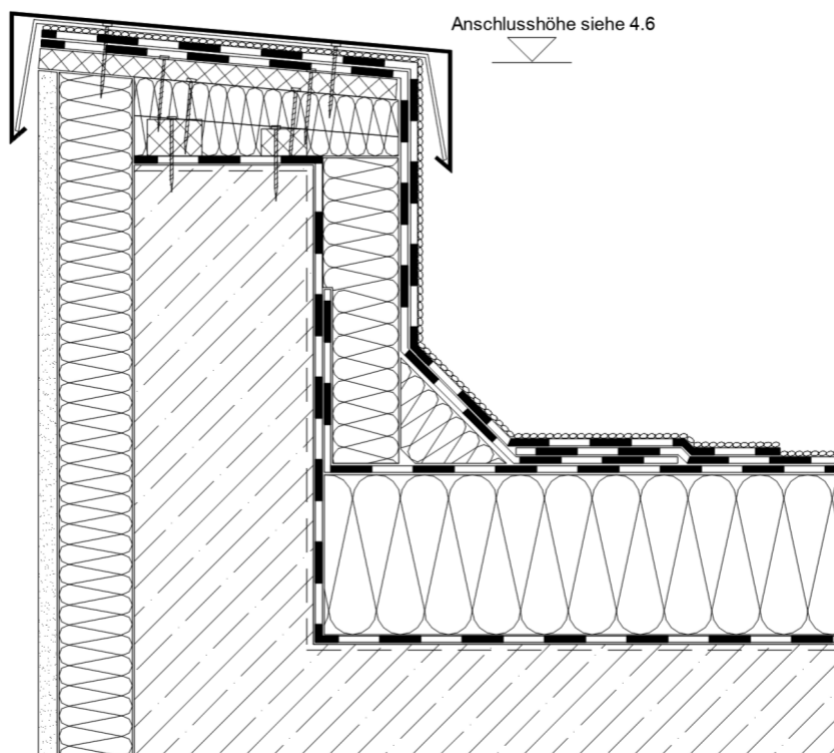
Starrer Dachrandabschluss – Ausführung mit Bitumenbahnen
